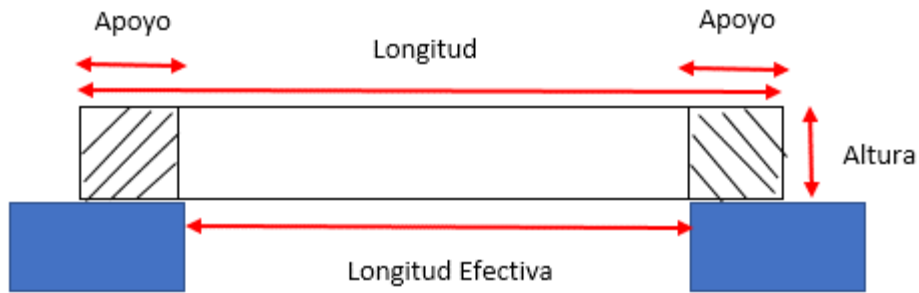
Partes de una viga para muestra de ensayo a flexión.
